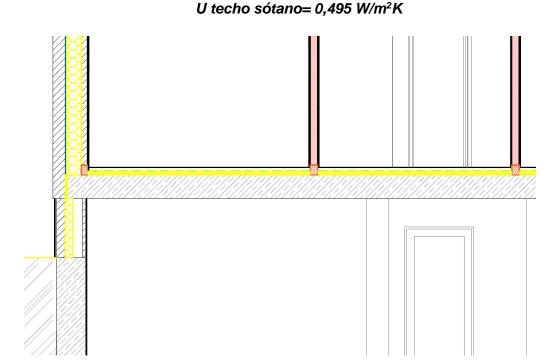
Sección semisótano – vivienda Planta Baja. Arranque tabiquería de ladrillo.
